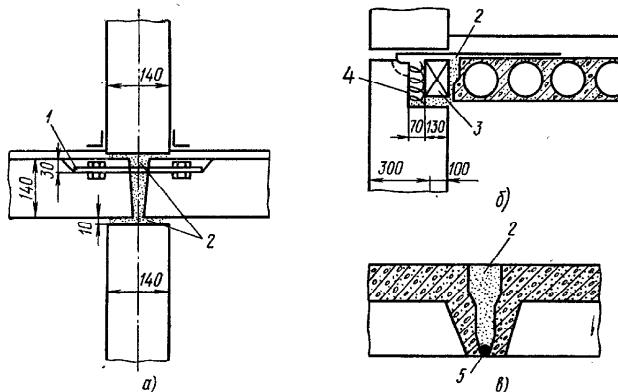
Типы стыков между плитами перекрытий и покрытий:
